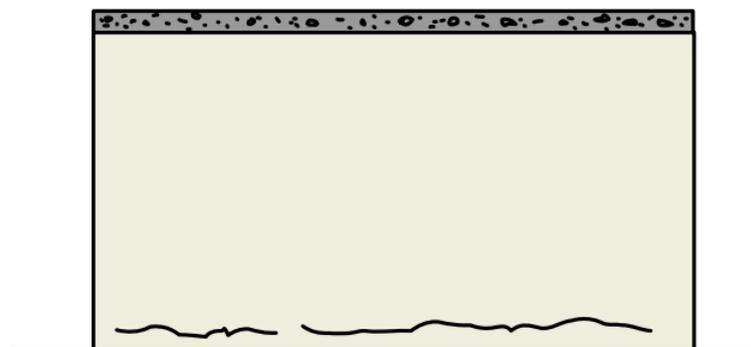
Fissuração horizontal causada pela movimentação higroscópica (Fonte: THOMAZ, 1989)
